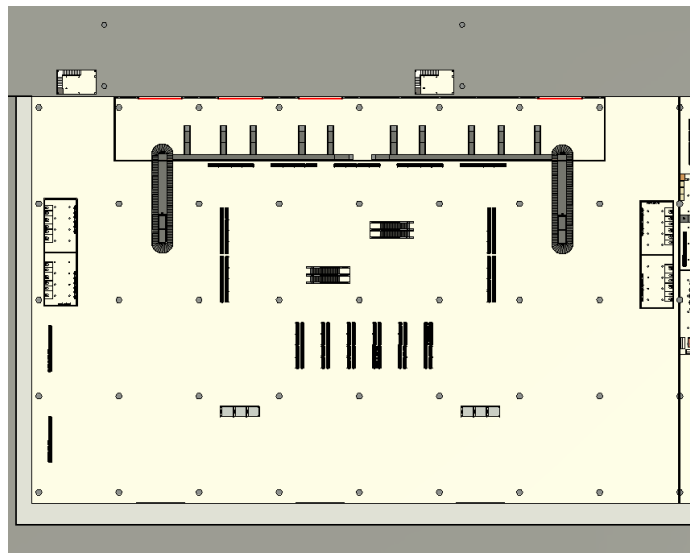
Vista de planta del vestíbulo inferior de llegadas.
